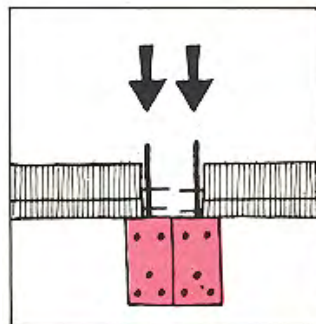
Traves dobles para recibir las viguetas de dos entre-ejes (caso más común).
